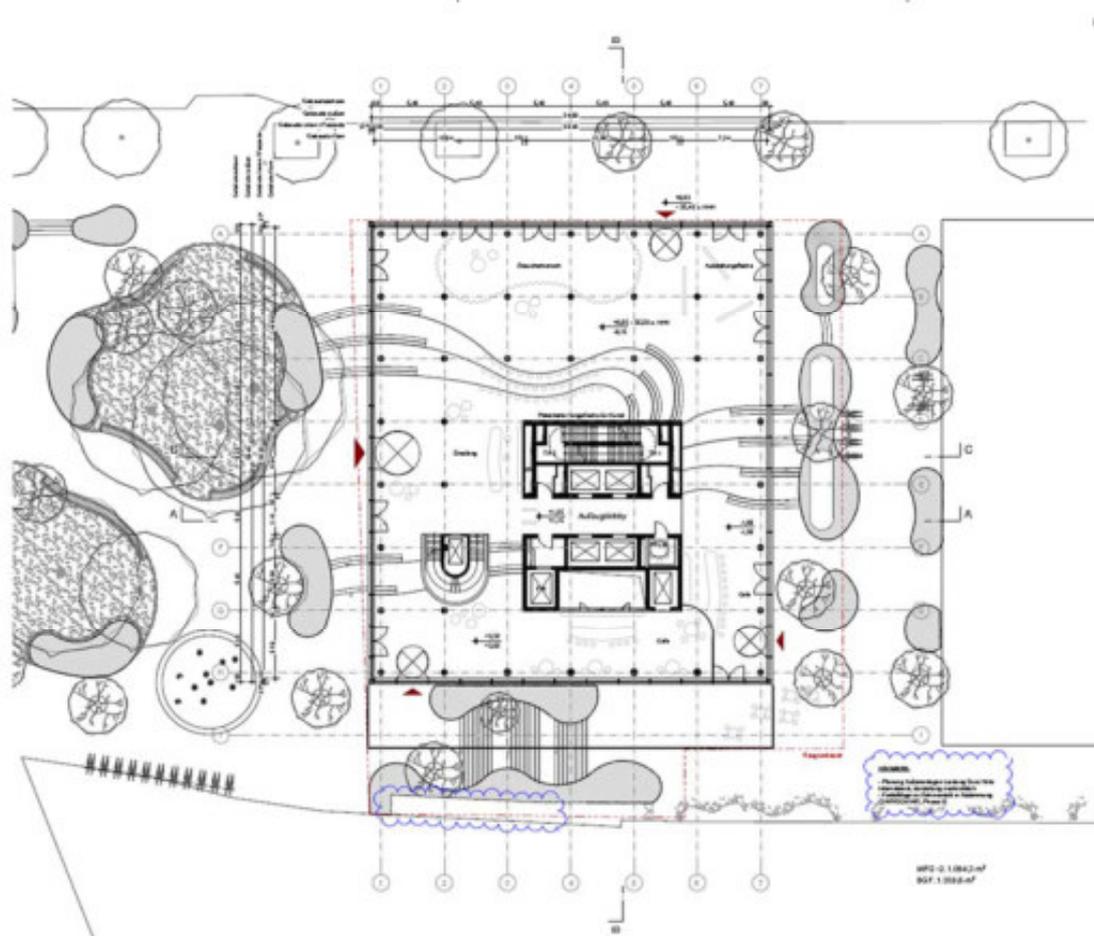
Grundriss EG, Vorentwurf Architekt David Chipperfield, Stand Januar 2021
